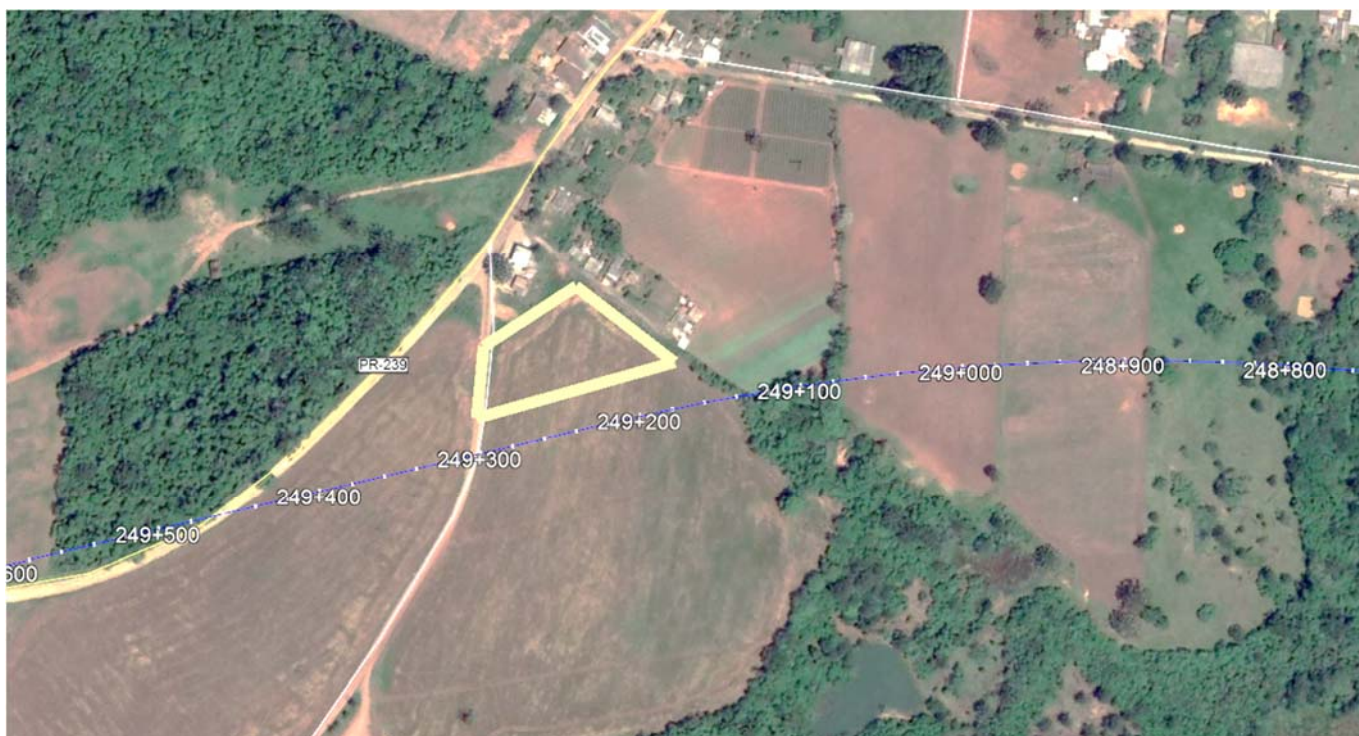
Sugestão de local para implantação do canteiro de obras.
